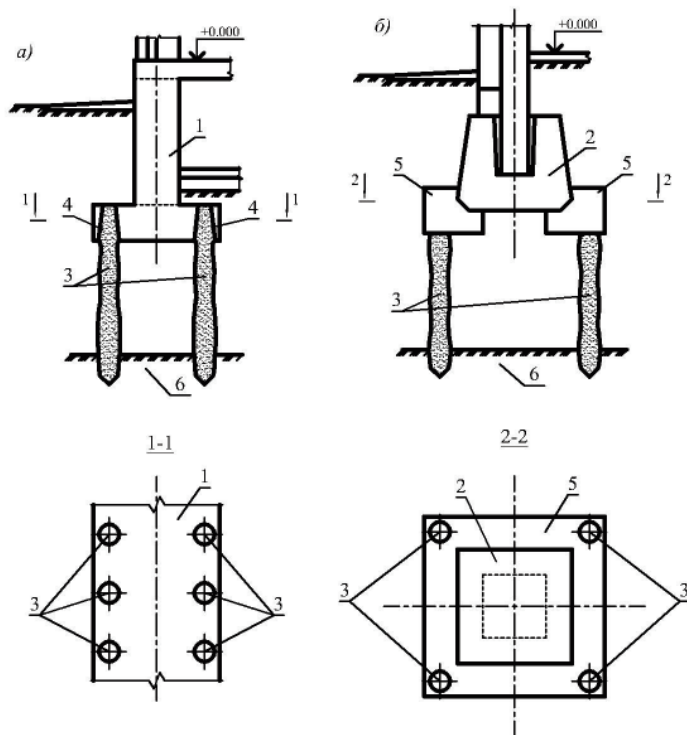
Схемы комбинированных фундаментов с инъекционными сваями: а, б – соответственно при устройстве свай непосредственно под подошвой существующего фундамента и вдоль контура или периметра его подошвы (ленточного и отдельного); 1 – существующий ленточный фундамент; 2 – существующий отдельный фундамент; 3 – инъекционные сваи; 4 – конусное отверстие в плитной части фундамента; 5 – железобетонная обойма; 6 – несущий слой грунта основания
